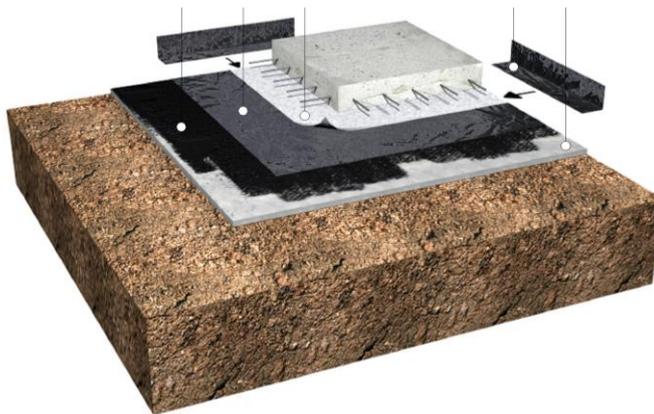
Impermeabilización de solera de hormigón sin aislamiento térmico
